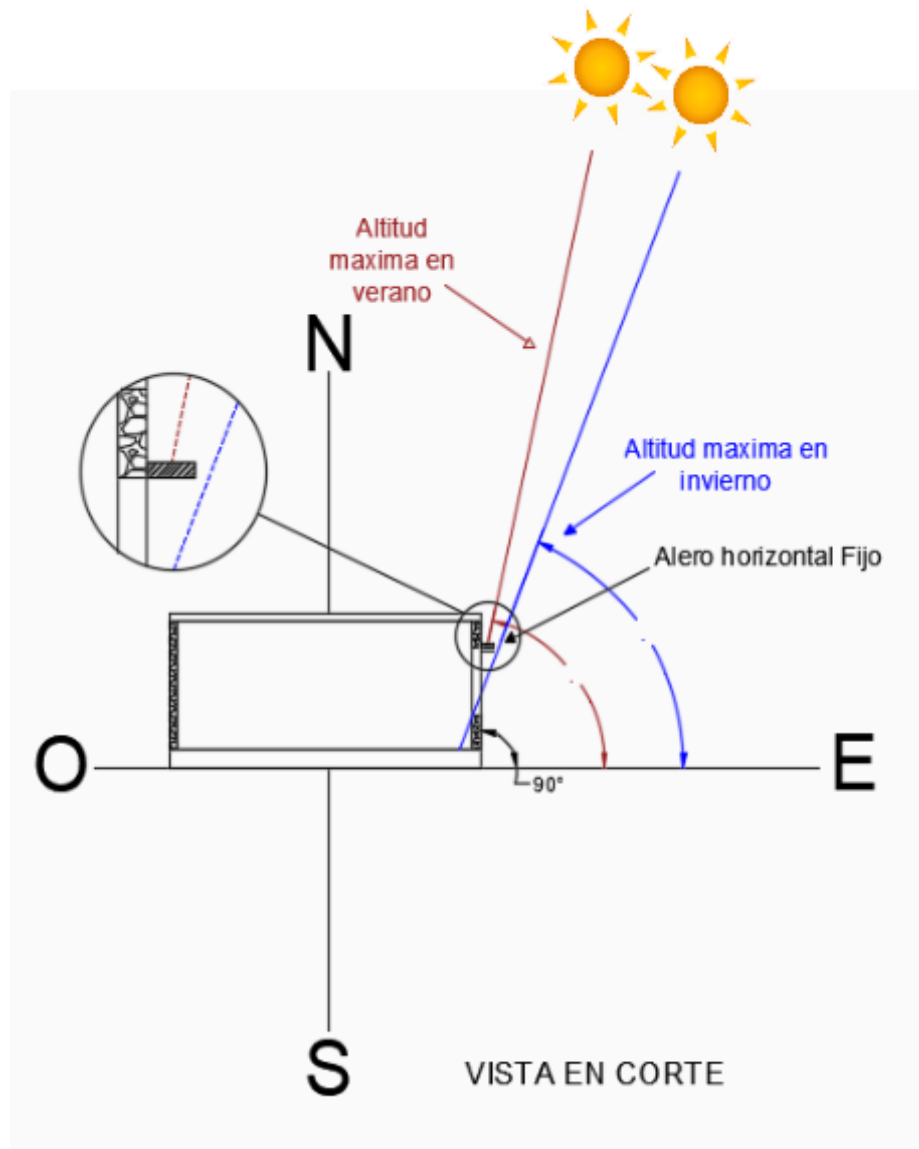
Detalle esquemático de aleros horizontales fijos. Fuente: Elaboración Propia
